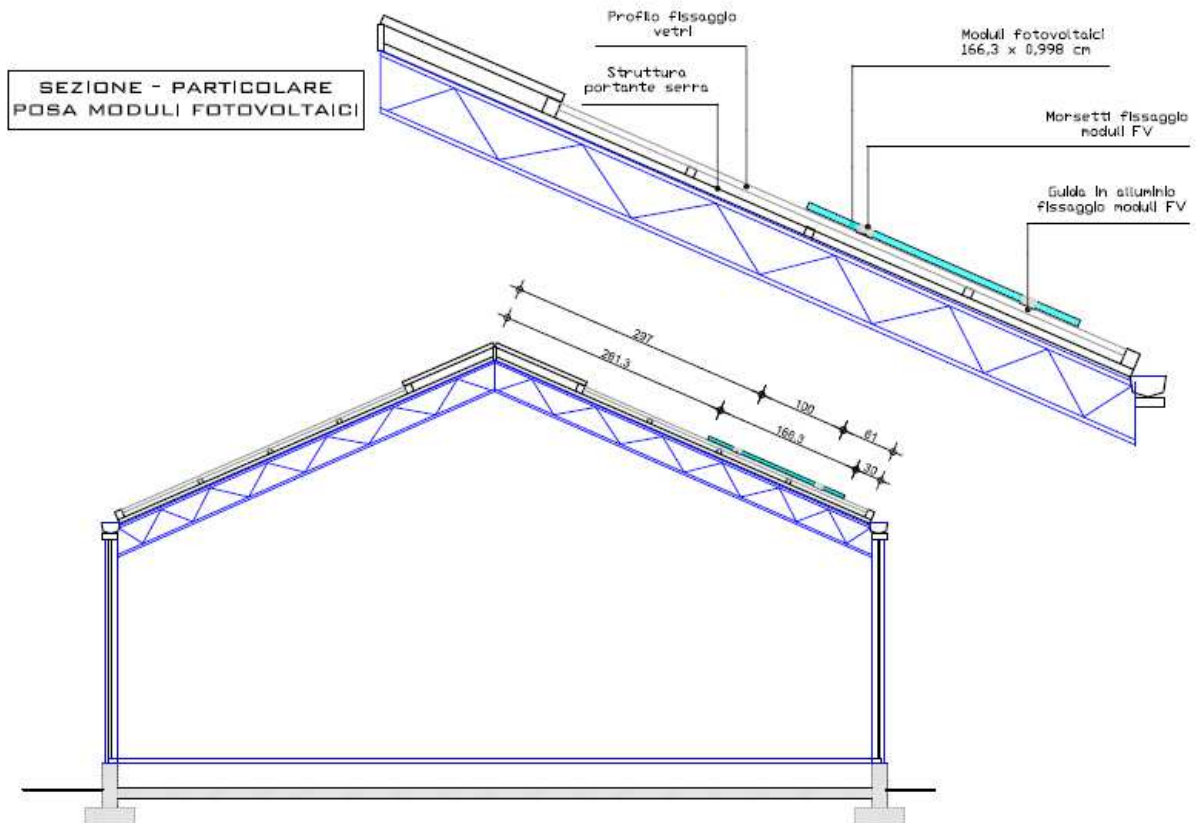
Impianto fotovoltaico – Tavola di progetto – Sezione trasversale
